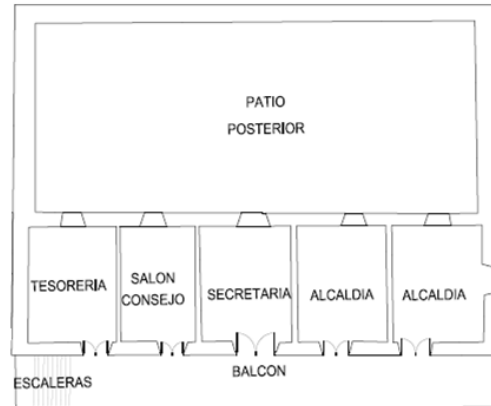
Planta segundo piso original (Uribe et al., 2013)
